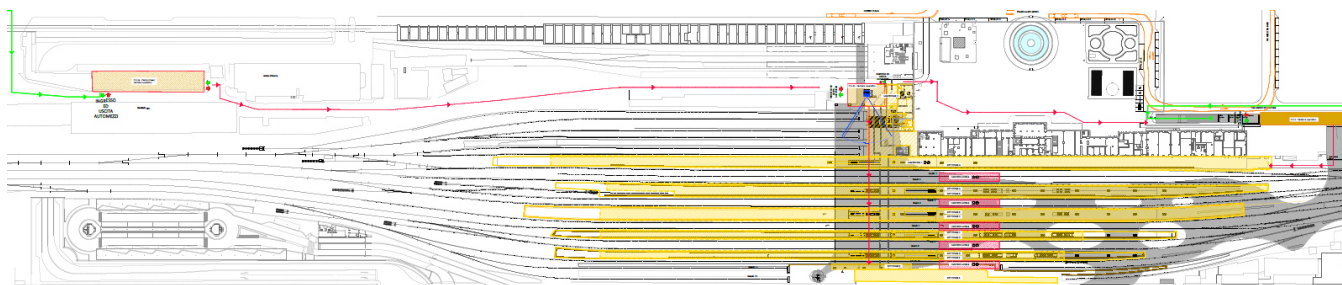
Planimetria delle macrofasi di realizzazione – piano del ferro
